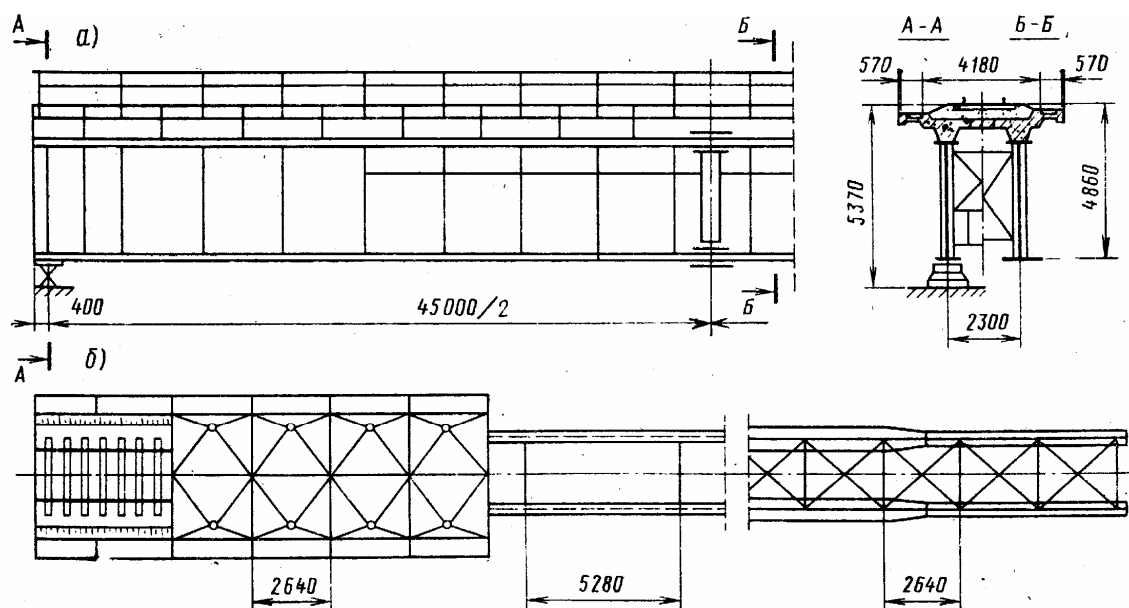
Сталежелезобетонное пролетное строение с ездой на балласте
